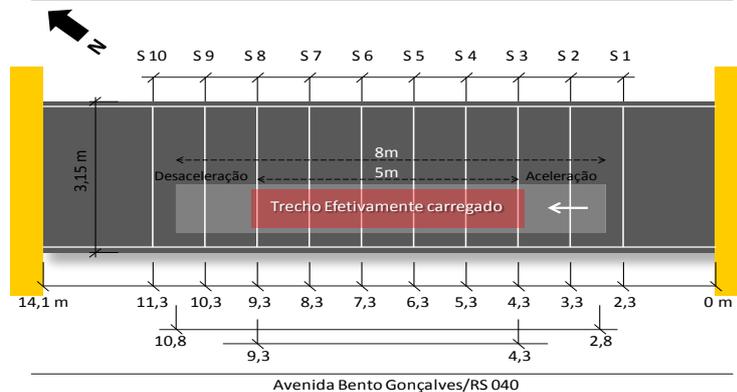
Pista experimental da Área de Testes de Pavimentos LAPAV/UFRGS
